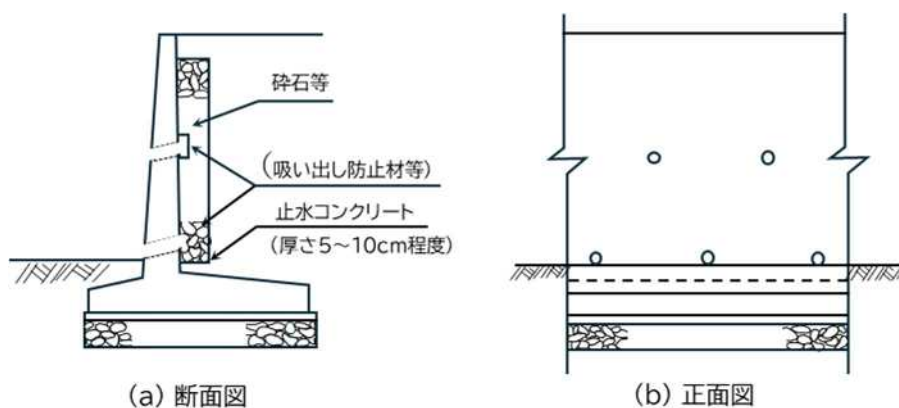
鉄筋コンクリート擁壁の断面図及び水抜穴設置図
